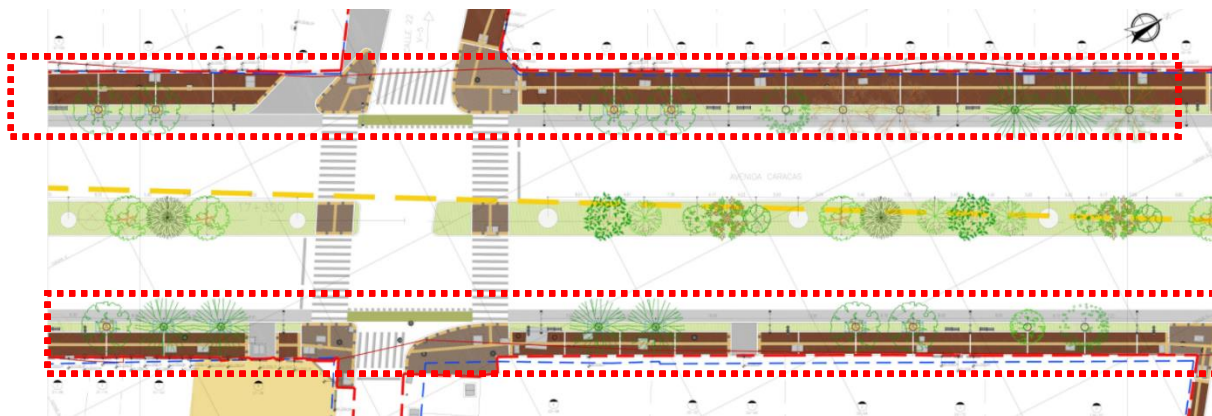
Planta tipología del arbolado paisaje lineal estructurante, interestación 213
